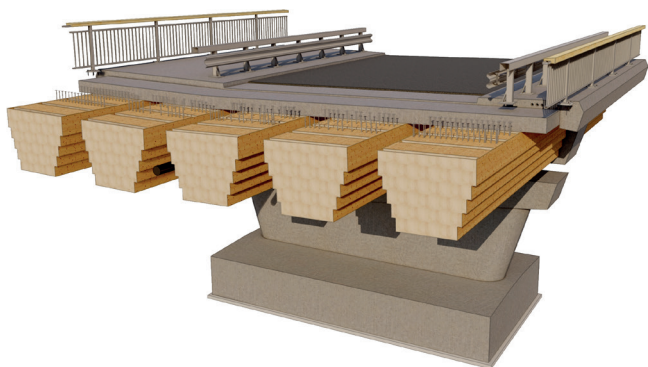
Tragwerksaufbau mit Schubverbund zwischen Betonplatte und Holzträgern
